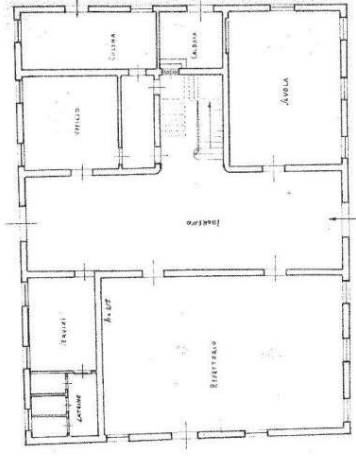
Fabbricato Part. 16. Planimetria Piano Terra
